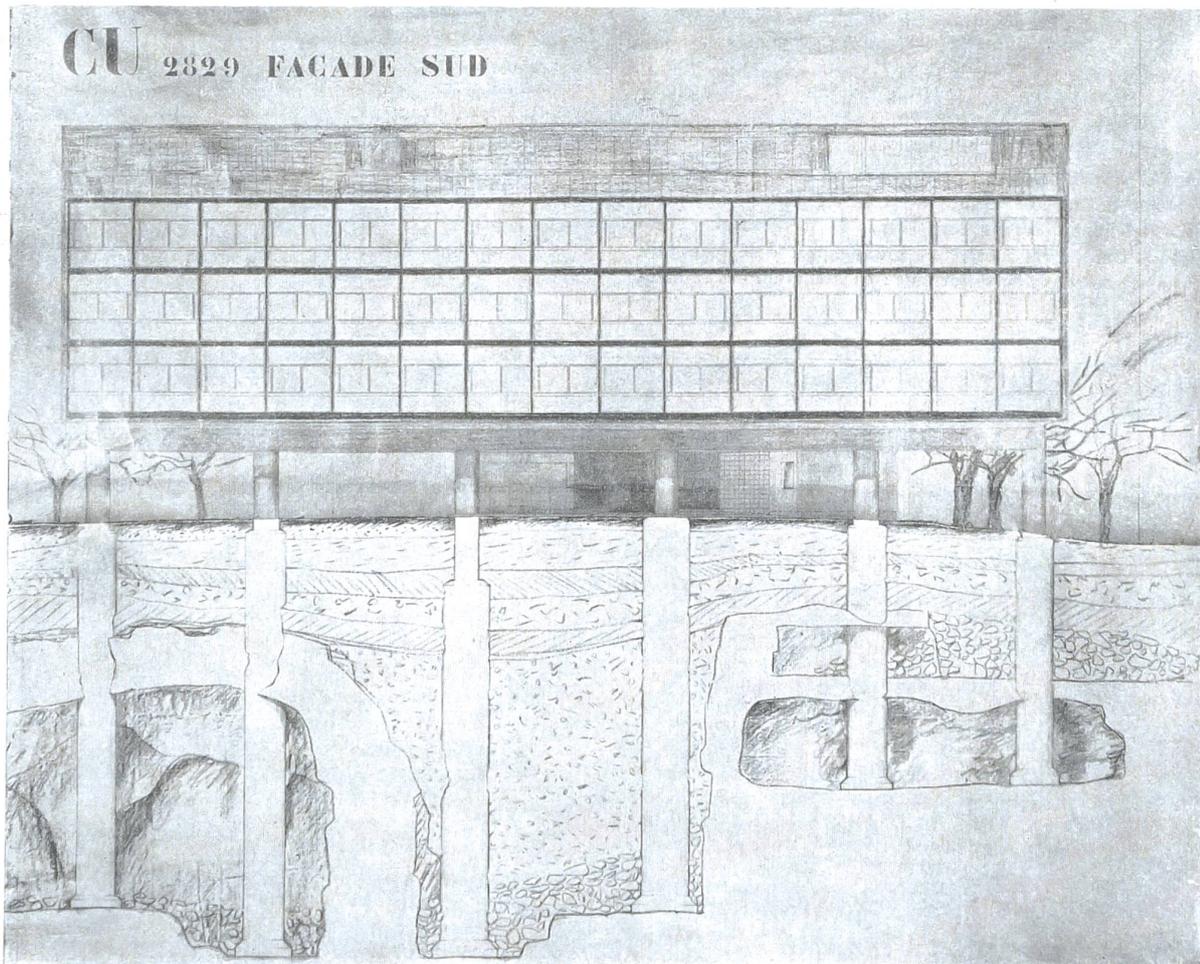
Fondations et façade du Pavillon suisse de la Cité universitaire de Paris.
